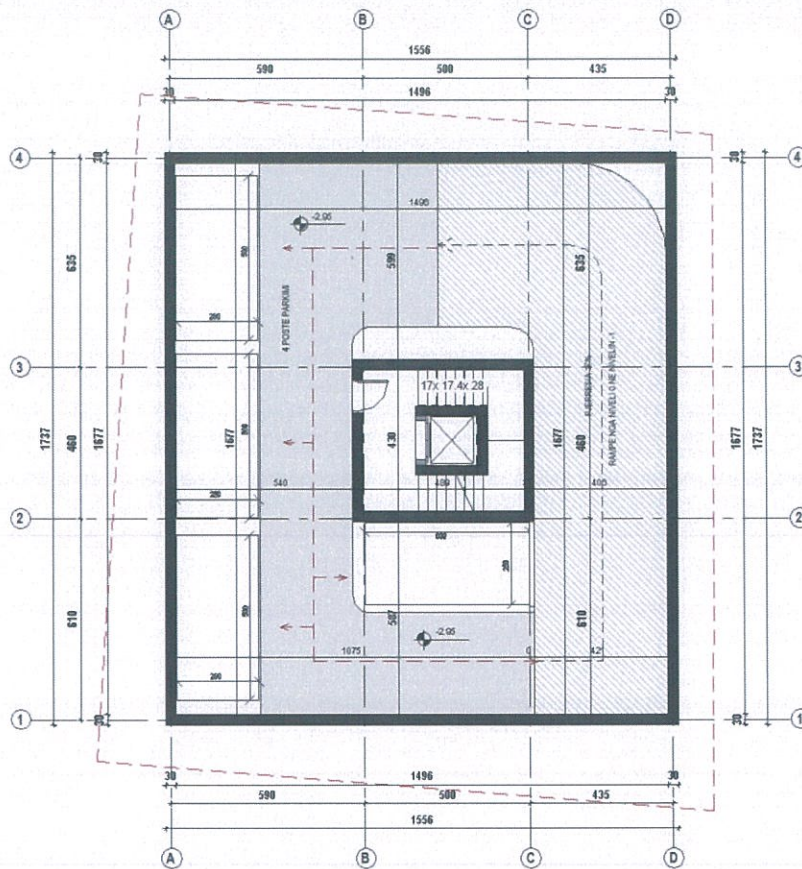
Planimetria e katit -1 me sipërfaqe 270.2 m² (parkim)
